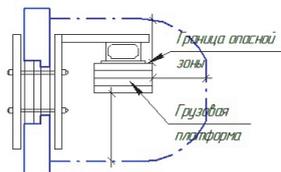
Опасная зона при работе грузового строительного подъемника
